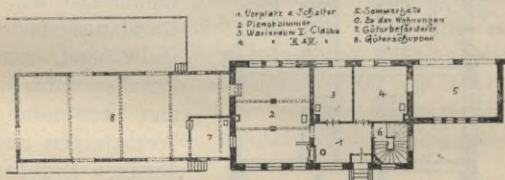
M. = 1:600. Empfangsgebäude Weilheim/Teck. Grundriß des Erdgeschosses.
